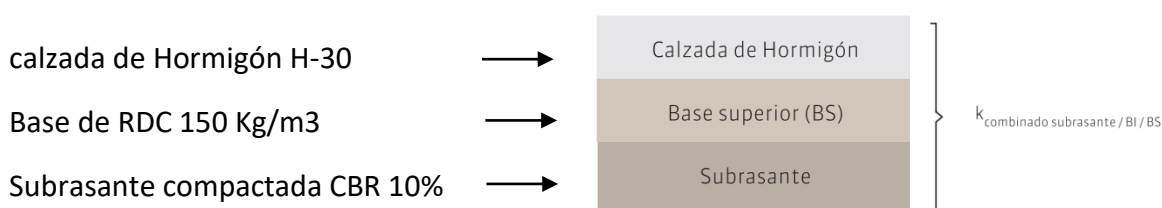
Modelo para el cómputo de la respuesta estructural del pavimento de hormigón.
